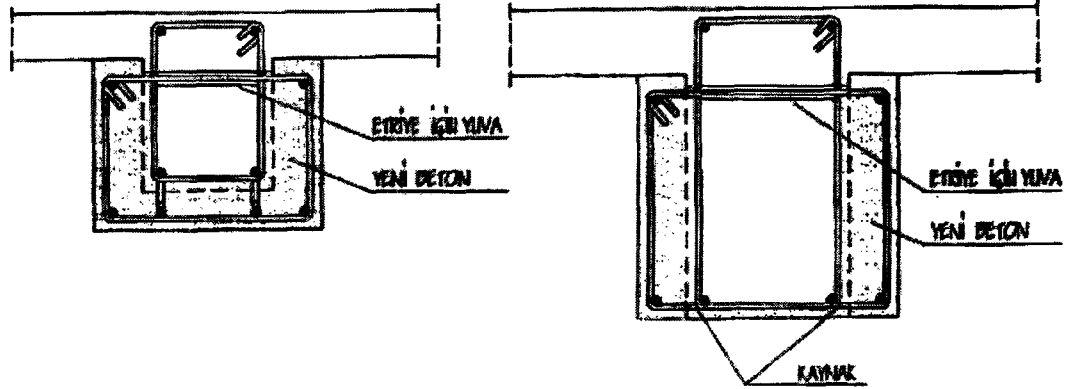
Betonarme kirişin dört yanından mantolanması
